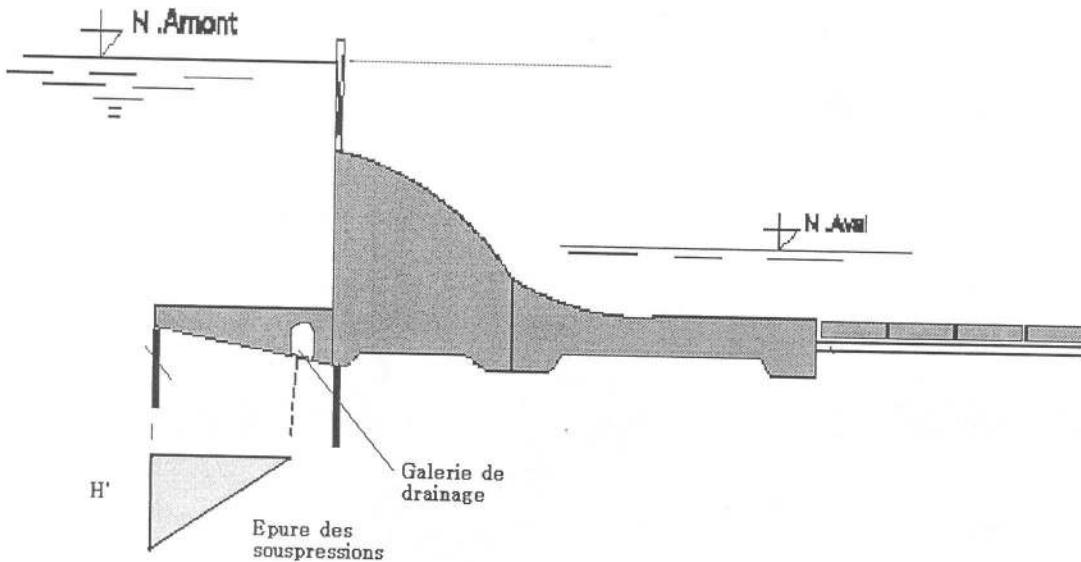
e : Avant radier avec deux palplanches et galerie de drainage
